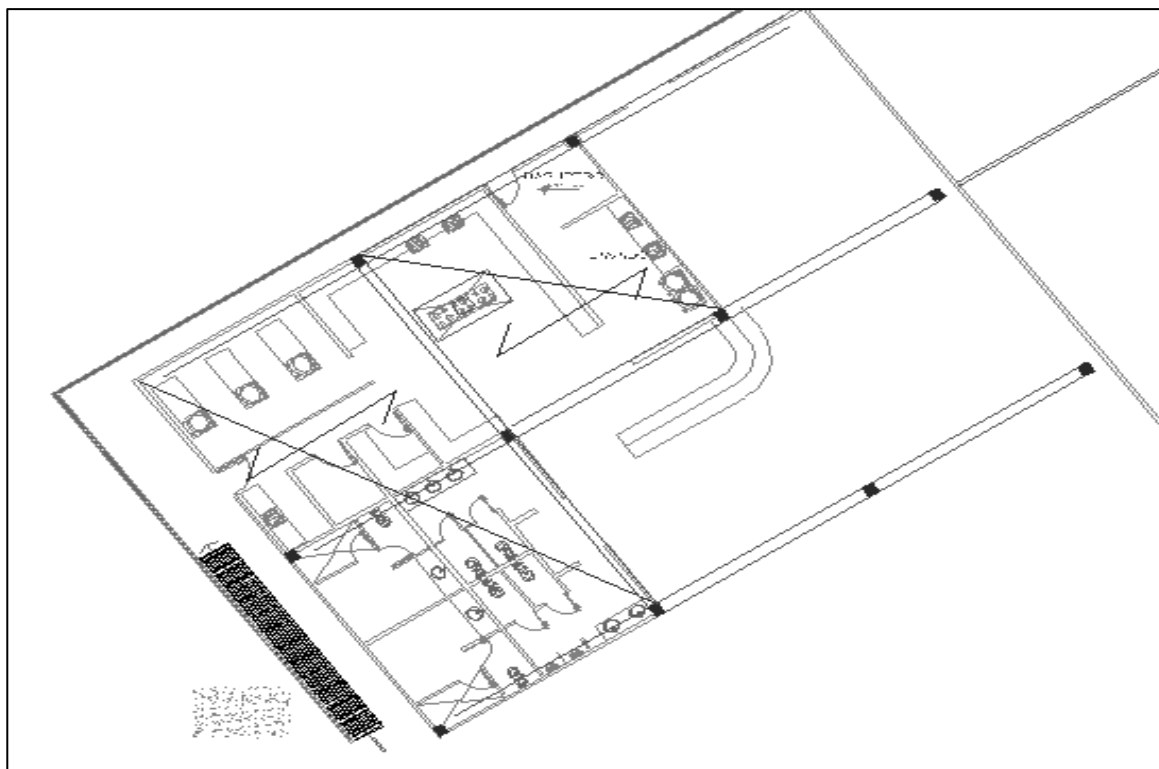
Plano estructuras restaurante. (Fuente: Elaboración Propia)
